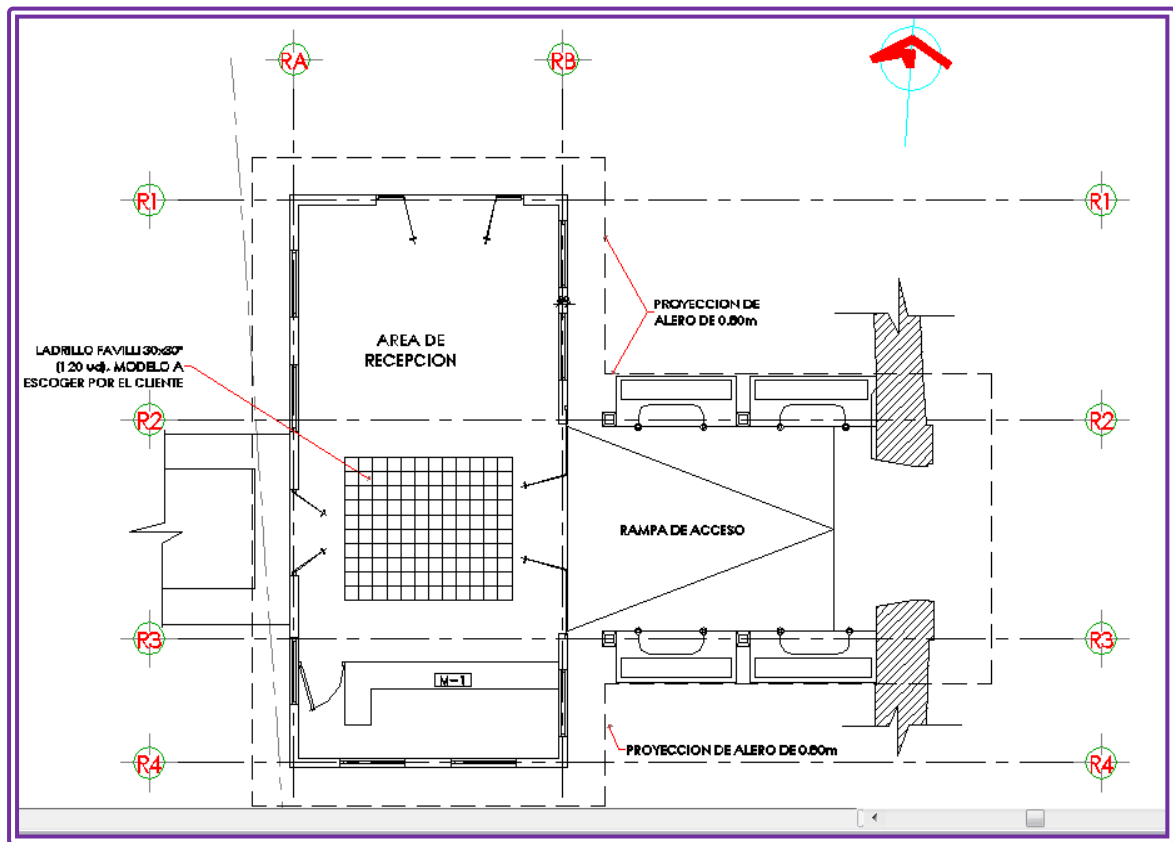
Planta de Arquitectónica de Edificio de Recepción.
